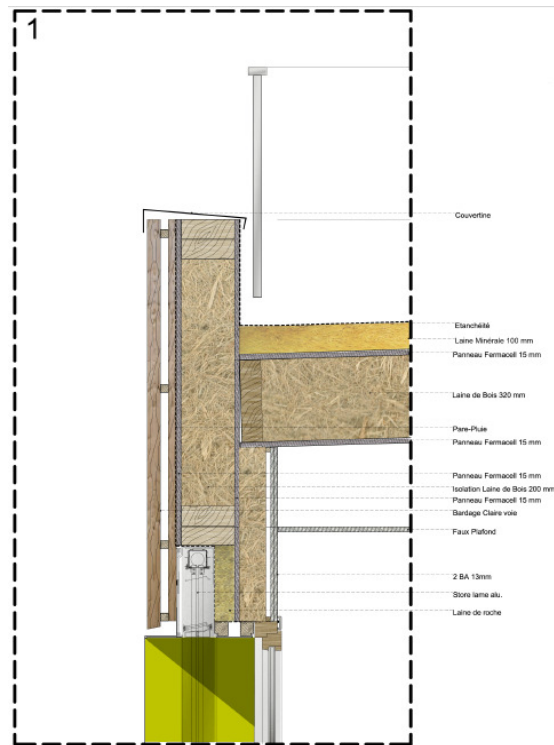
DETAIL D'UN ANGLE DU GROUPE SCOLAIRE
